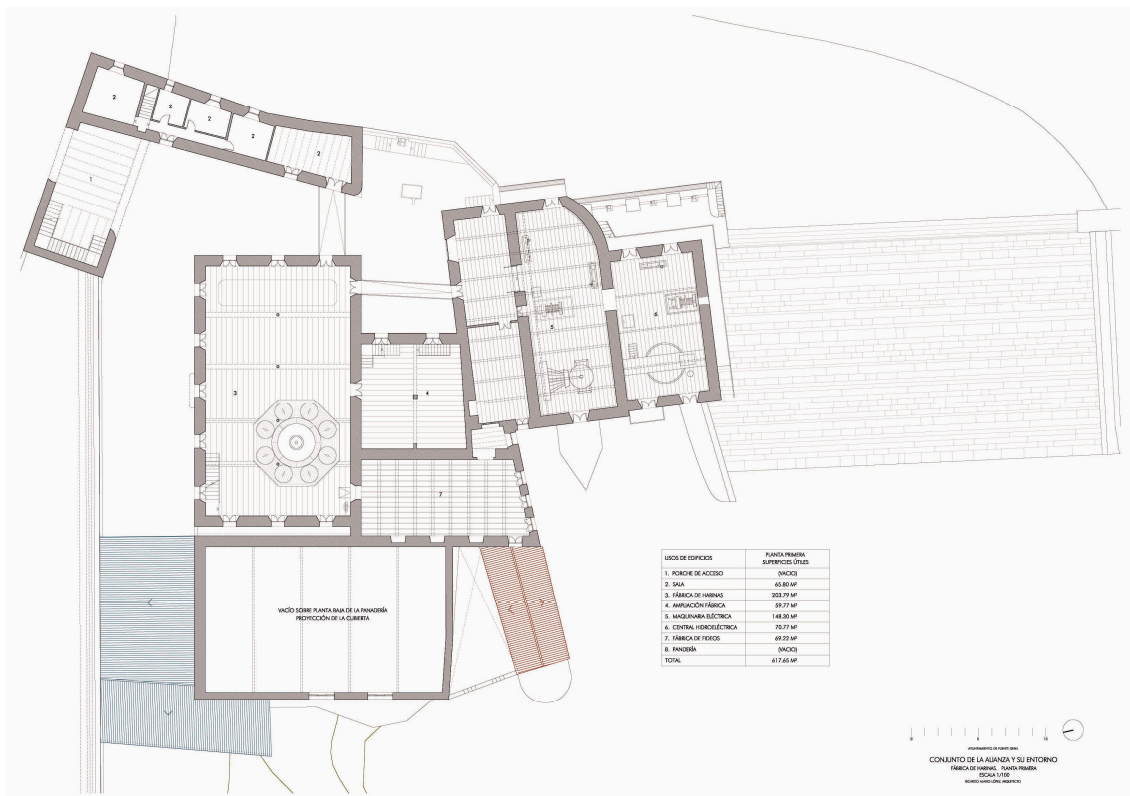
Conjunto de La Alianza y su entorno. Planta primera. Escala 1/100. Fuente: Ricardo Alario López (arquitecto).
